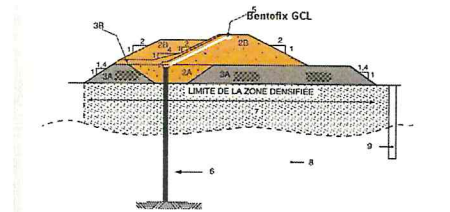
coupe transversale de la construction retenue du ponton Sainte-Marguerite
